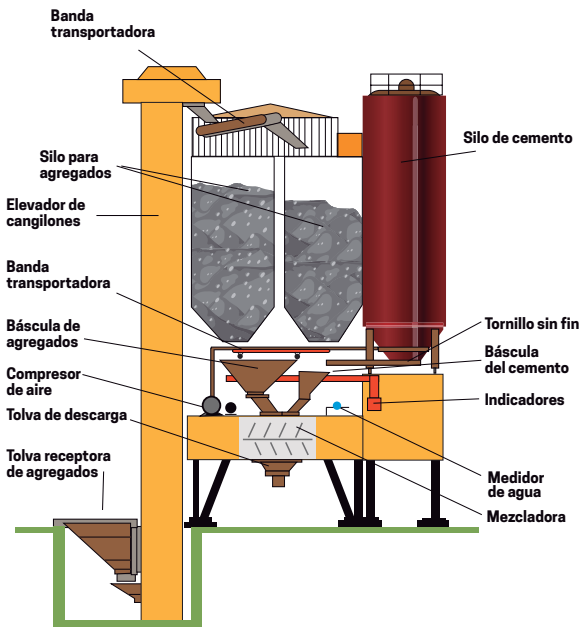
Planta de mezclas de concreto tipo torre (11.18)
